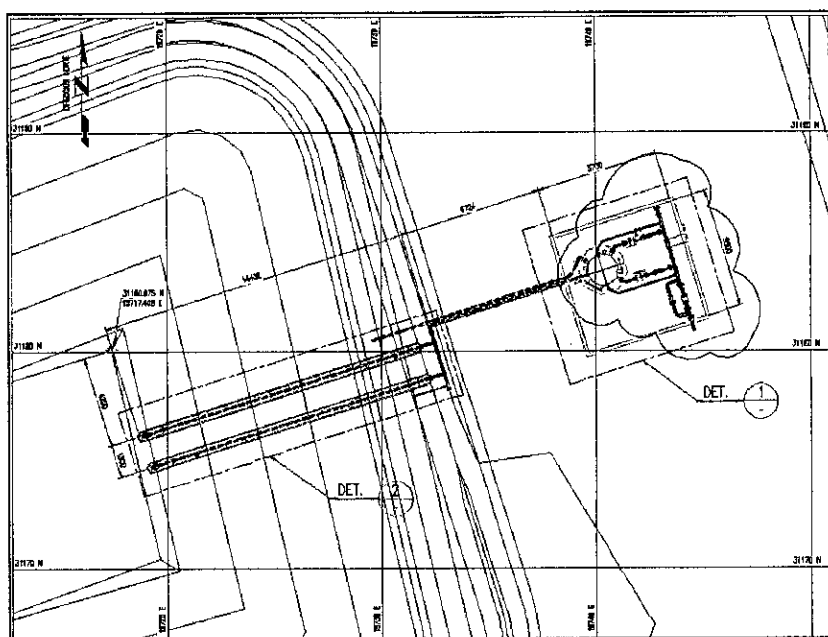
Ubicación de las líneas de tuberías que provinieron del tanque de transferencia 6760-TK-15001, dentro del plano de construcción – Fuente MYSRL
